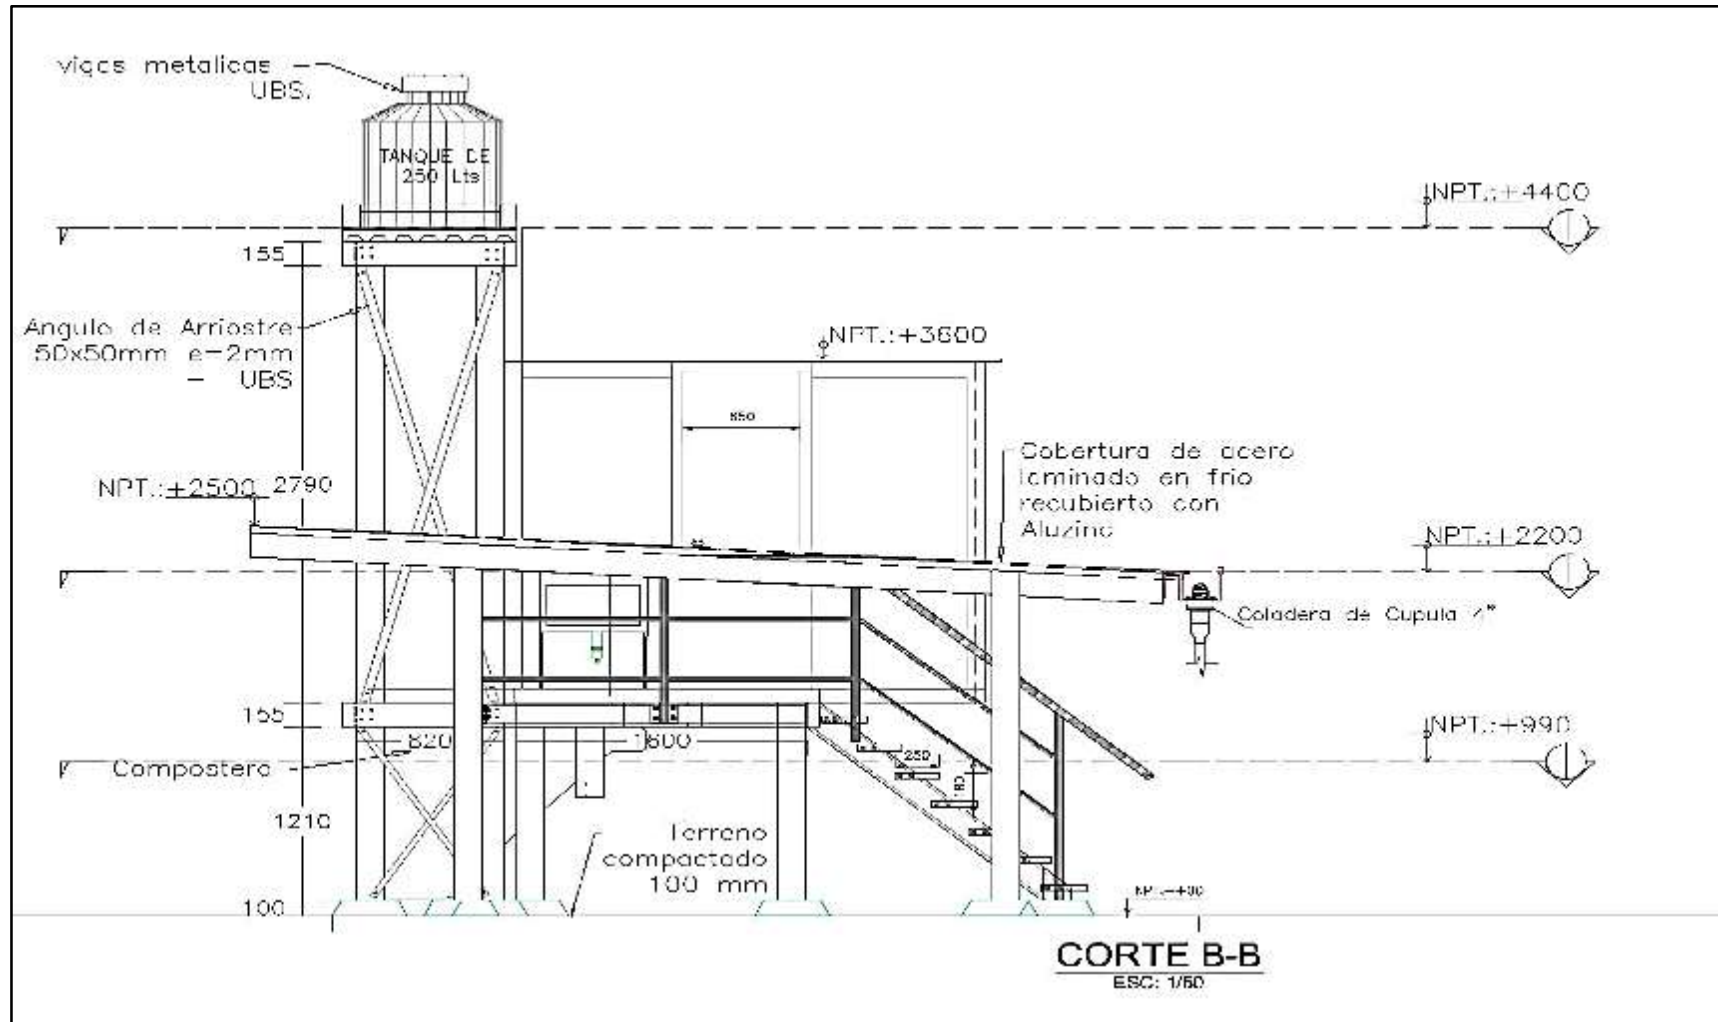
Plano de Estructuras – Corte B-B del módulo domiciliario UBS mediante el sistema Steel Framing
